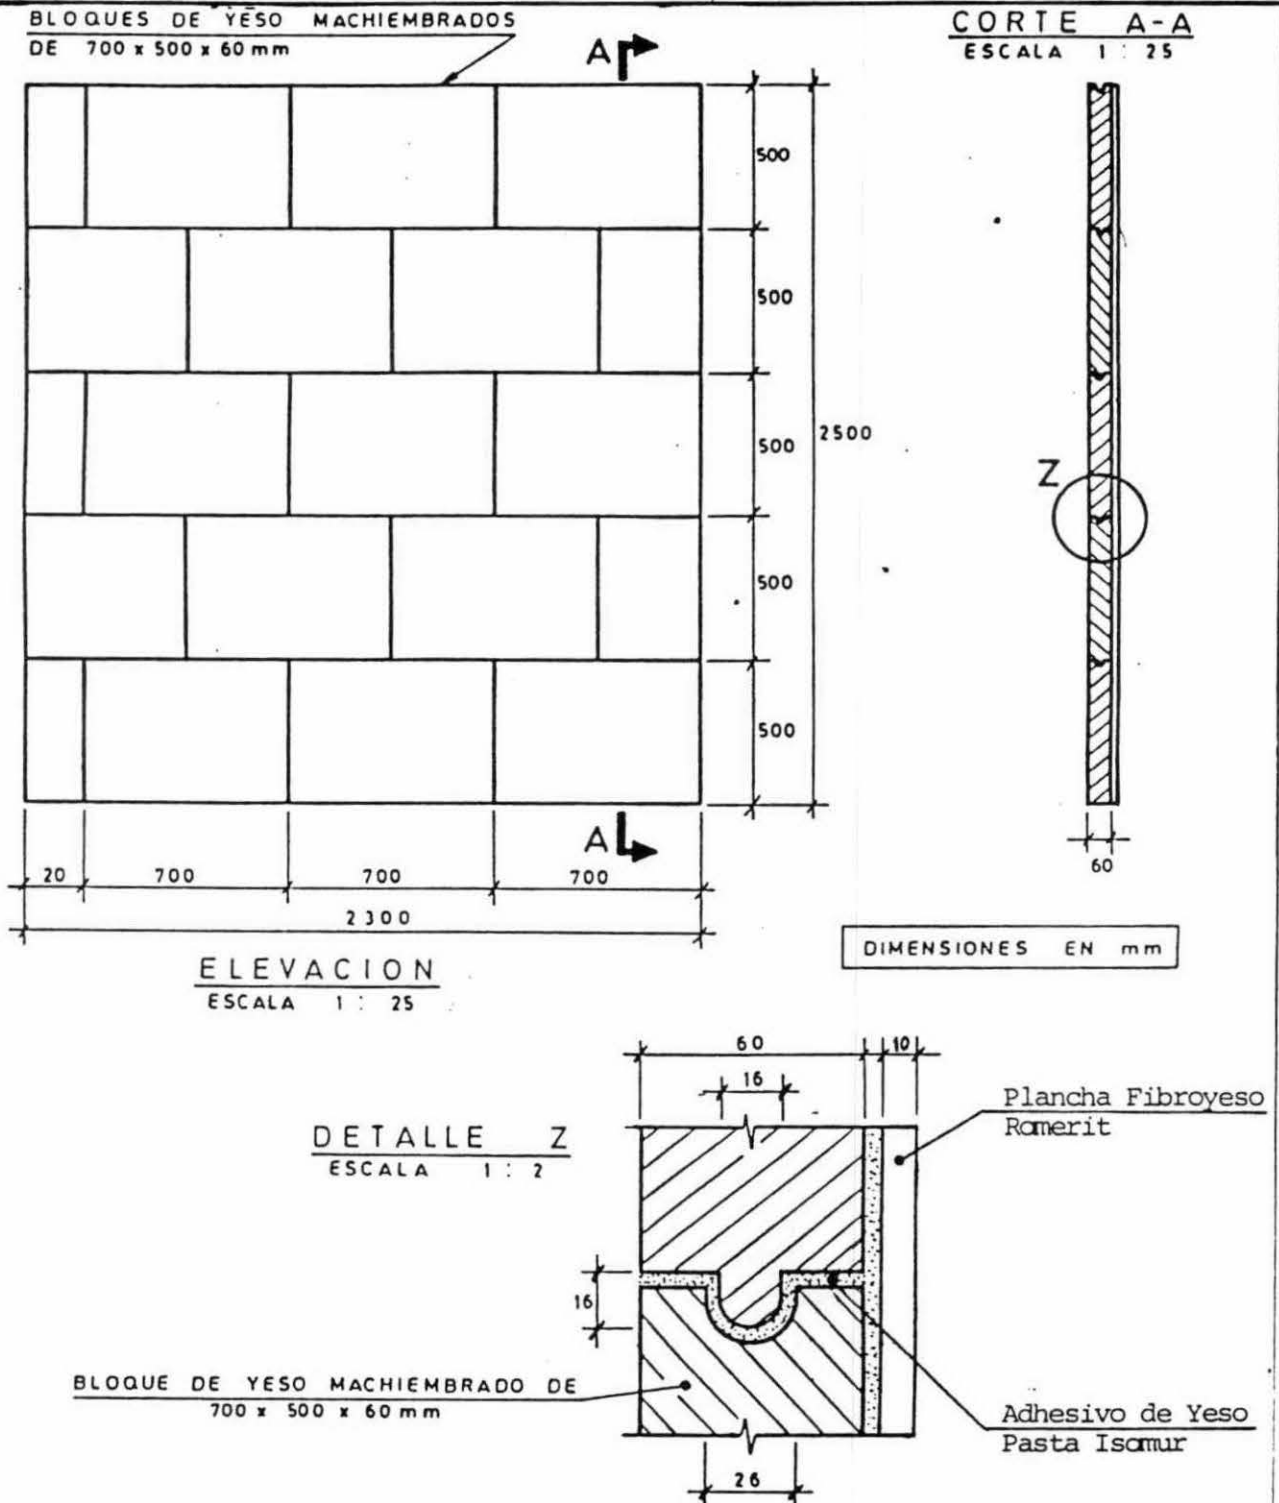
ELEVACION, CORTE Y DETALLE DEL MURO.
